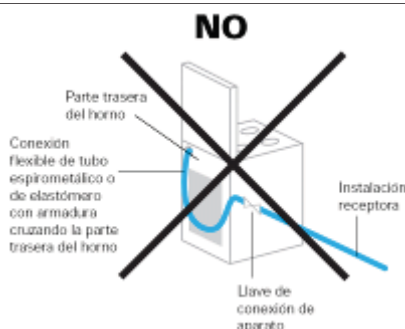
Posición Conexión flexible de elastómero con armadura interna o externa
